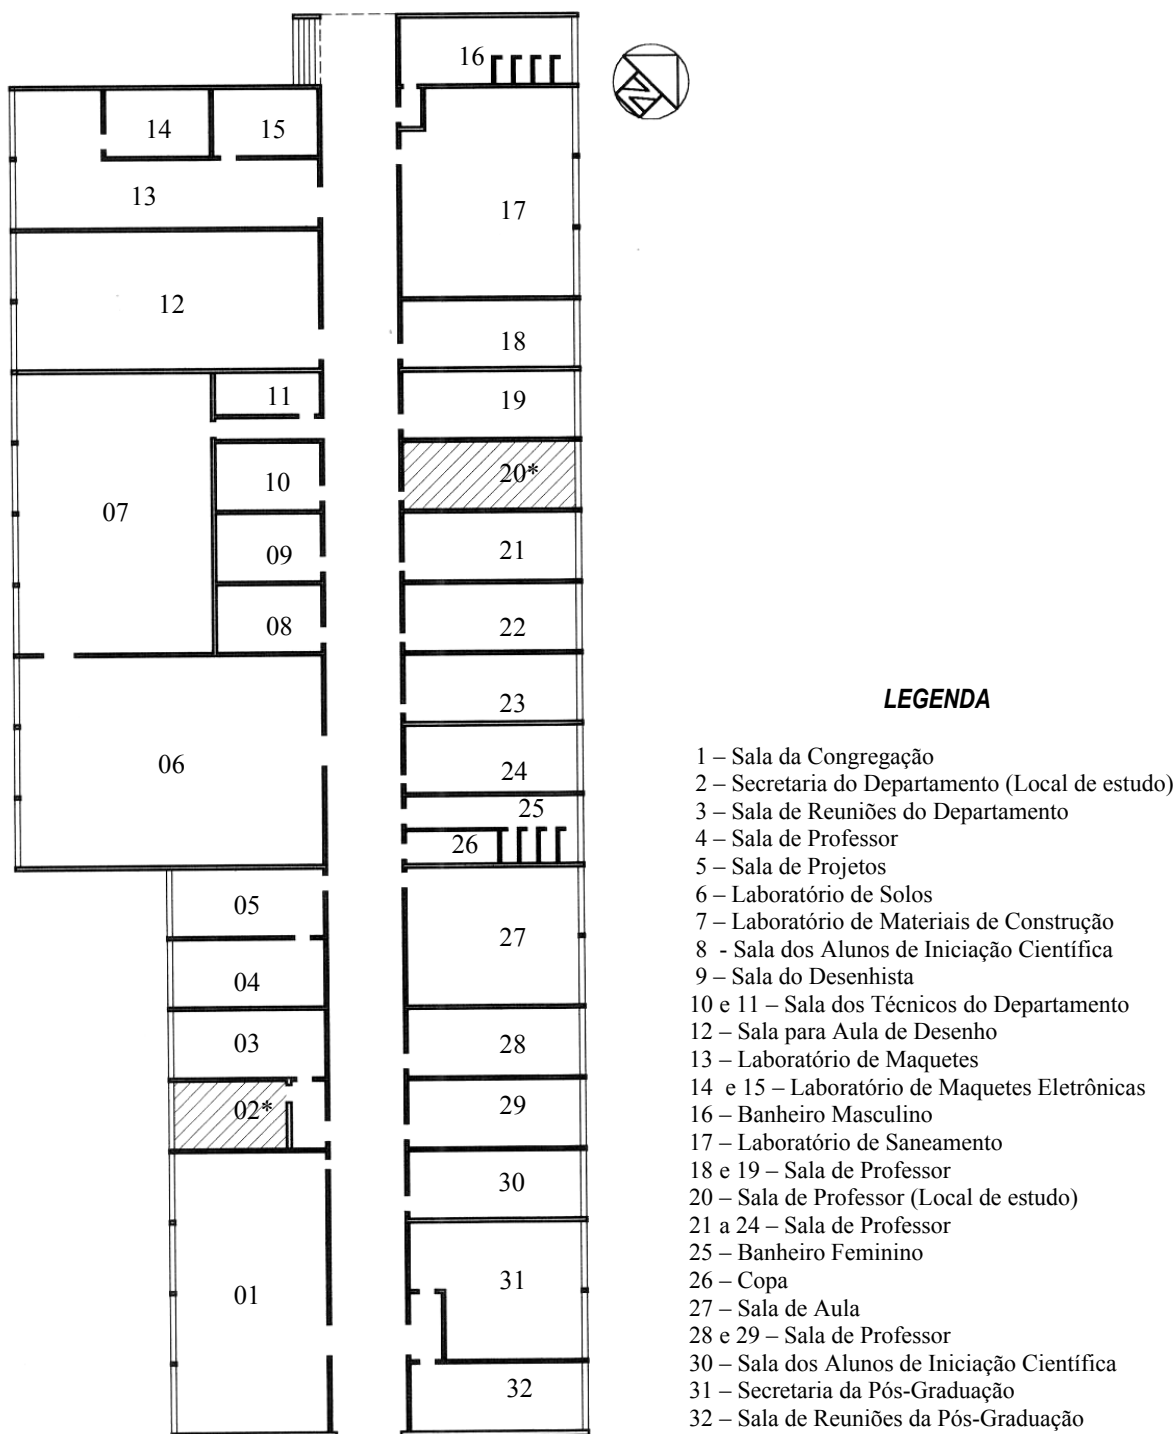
Planta do Departamento de Engenharia Civil da UNESP - Guaratinguetá
